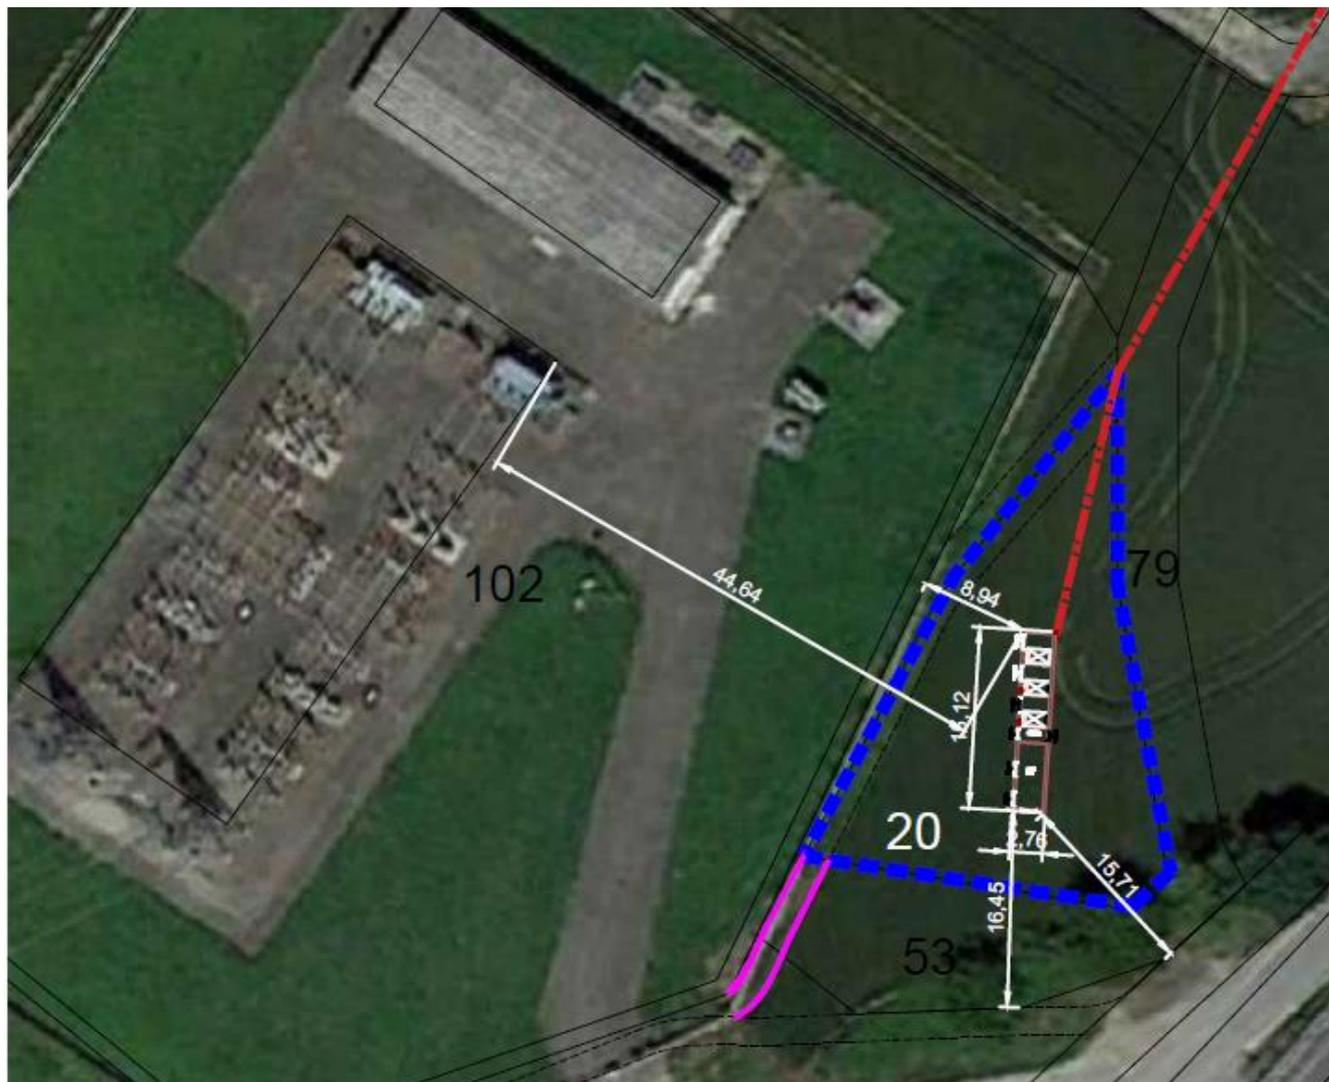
POSIZIONE DELLA CABINA DI CONSEGNA NEL LOTTO RISPETTO ALLA POSIZIONE DELLA SOTTOSTAZIONE AT AULARA
